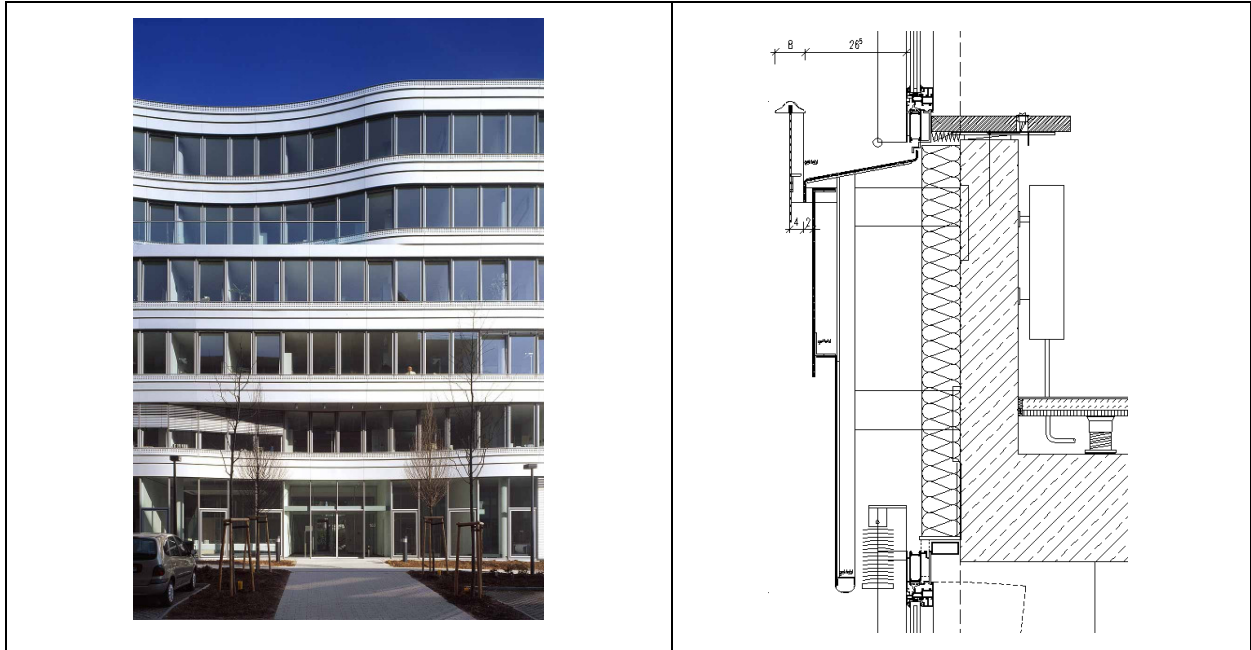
3: Ansicht und Detailschnitt Fassade [Quelle: Ed. Züblin AG].
